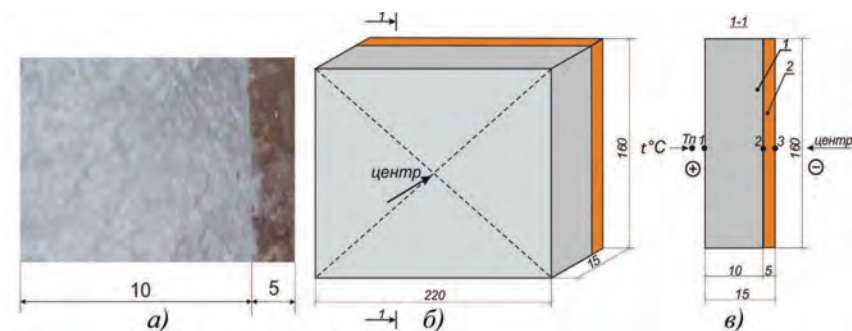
Металева пластина (сталь Ст5сп): а) оброблена композицією на основі спученого перліту товщиною 10 мм; б) габаритні розміри конструкції; в) у розрізі
